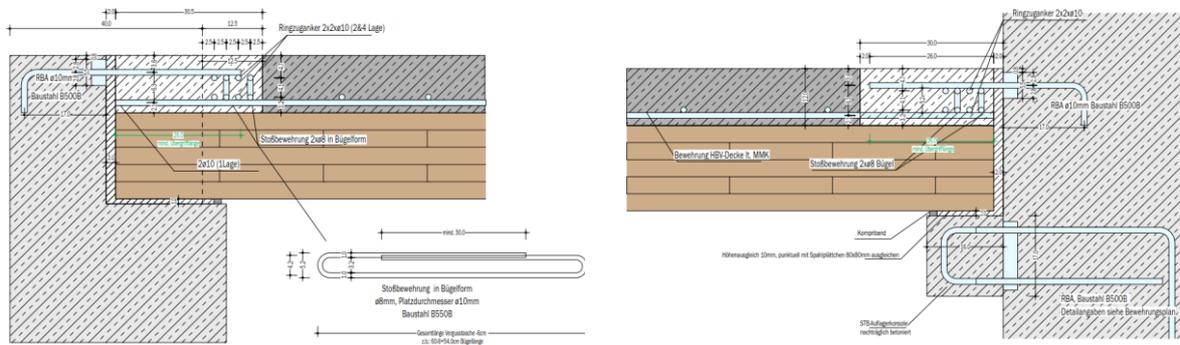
Deckenauflegerdetails mit Bewehrungsanschlüssen
